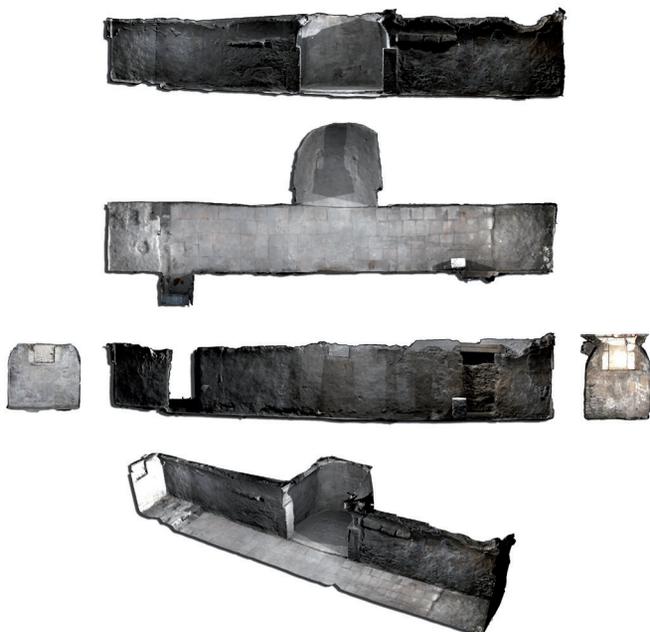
Vista tridimensionale dell'intera struttura ipogea
